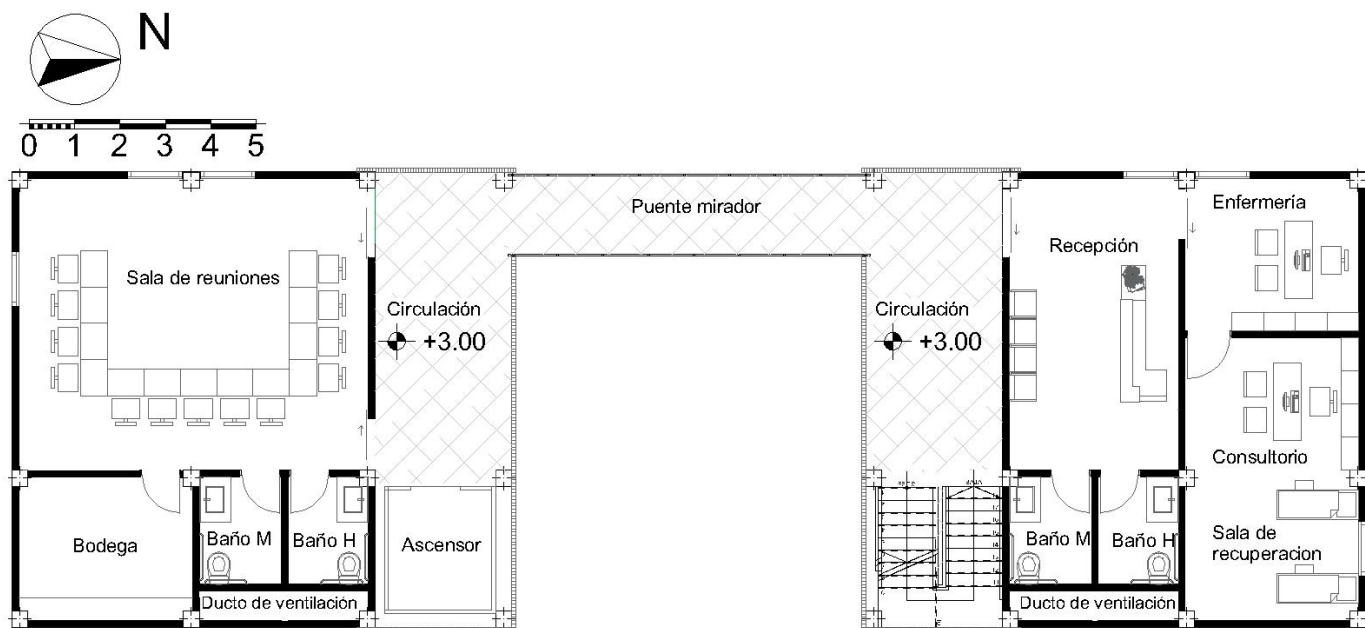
Planta arquitectónica, plataforma 0, planta baja
